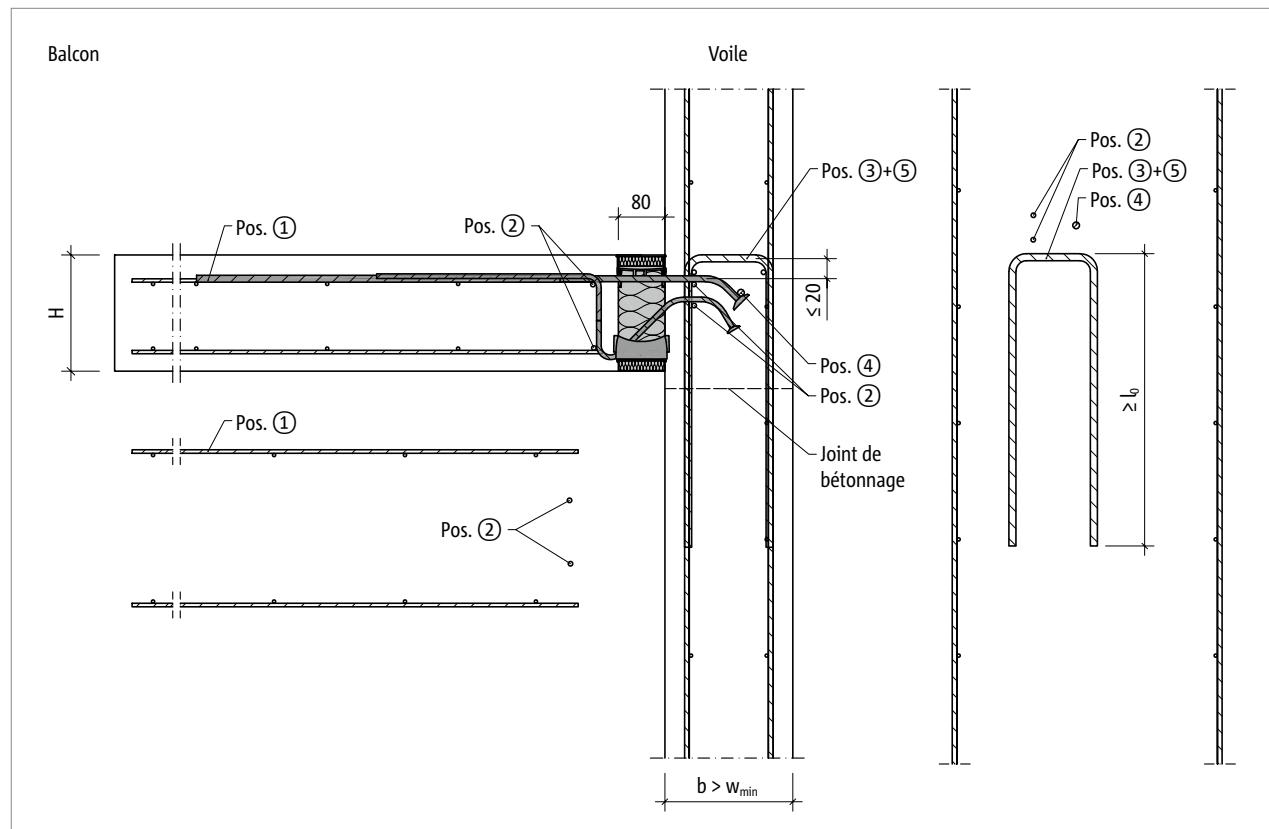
Schöck Isokorb® T type K-O : Renforcement sur site pour raccordement mural avec une dimension plus grande du composant ($w_{\text{pres}} > w_{\min}$)
